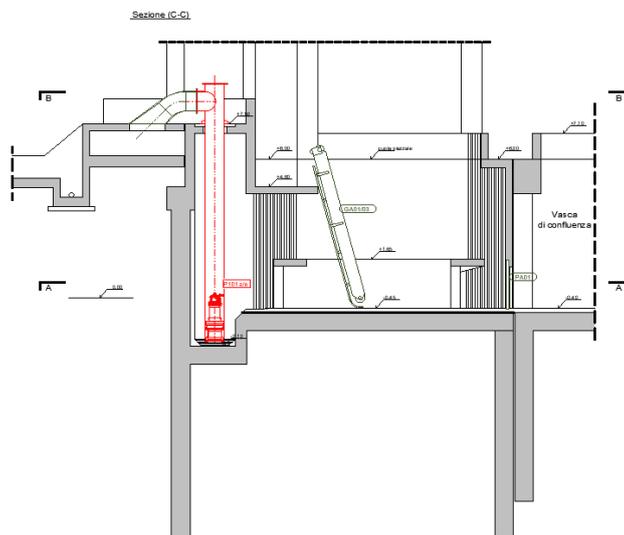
Sollevamento iniziale - Stato di progetto – Sezione
